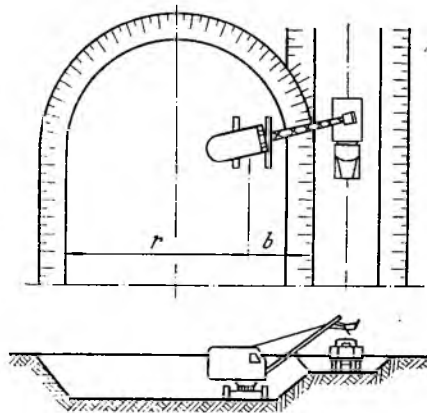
Схема разработки выемки продольными проходками экскаватора, оборудованного прямой лопатой
